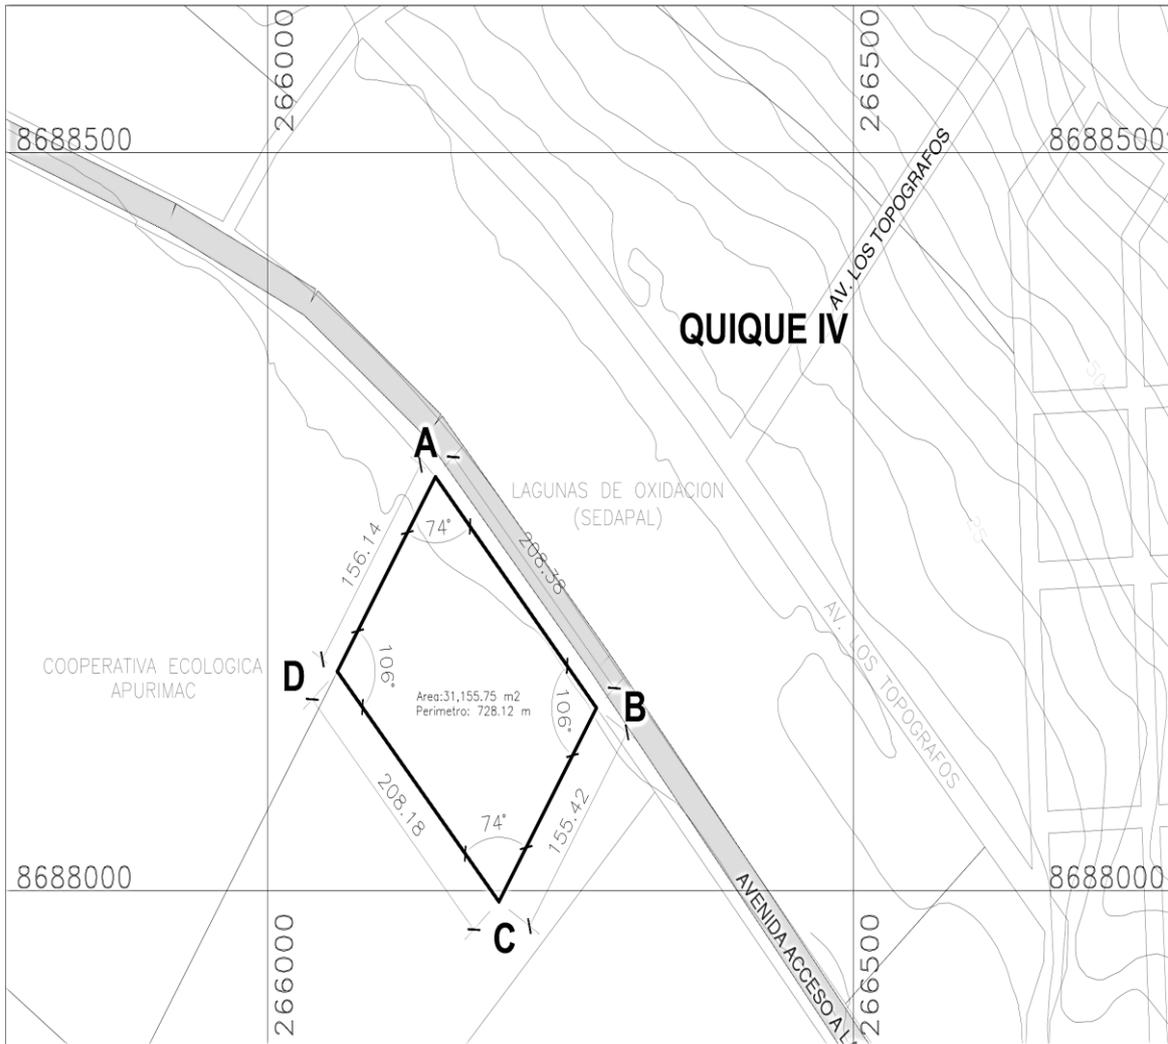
Plano de Ubicación del terreno, elaboración propia.
